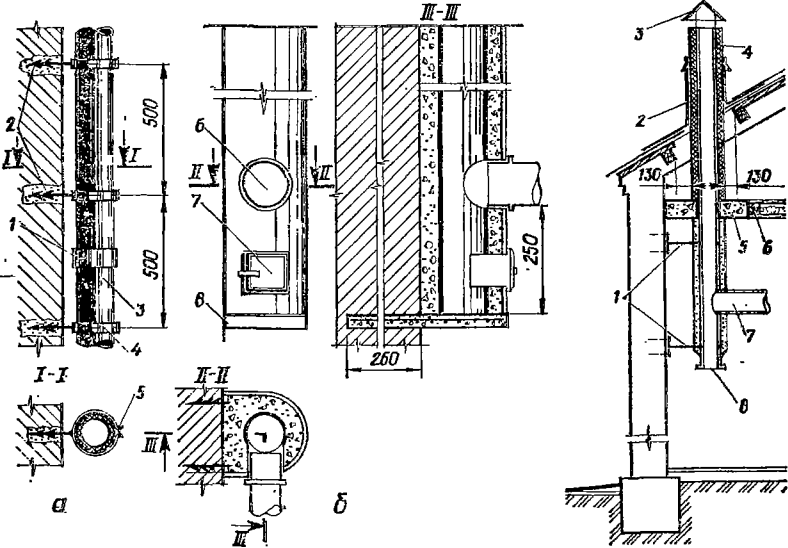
Крепление асбестоцементных труб к стенам здания:
